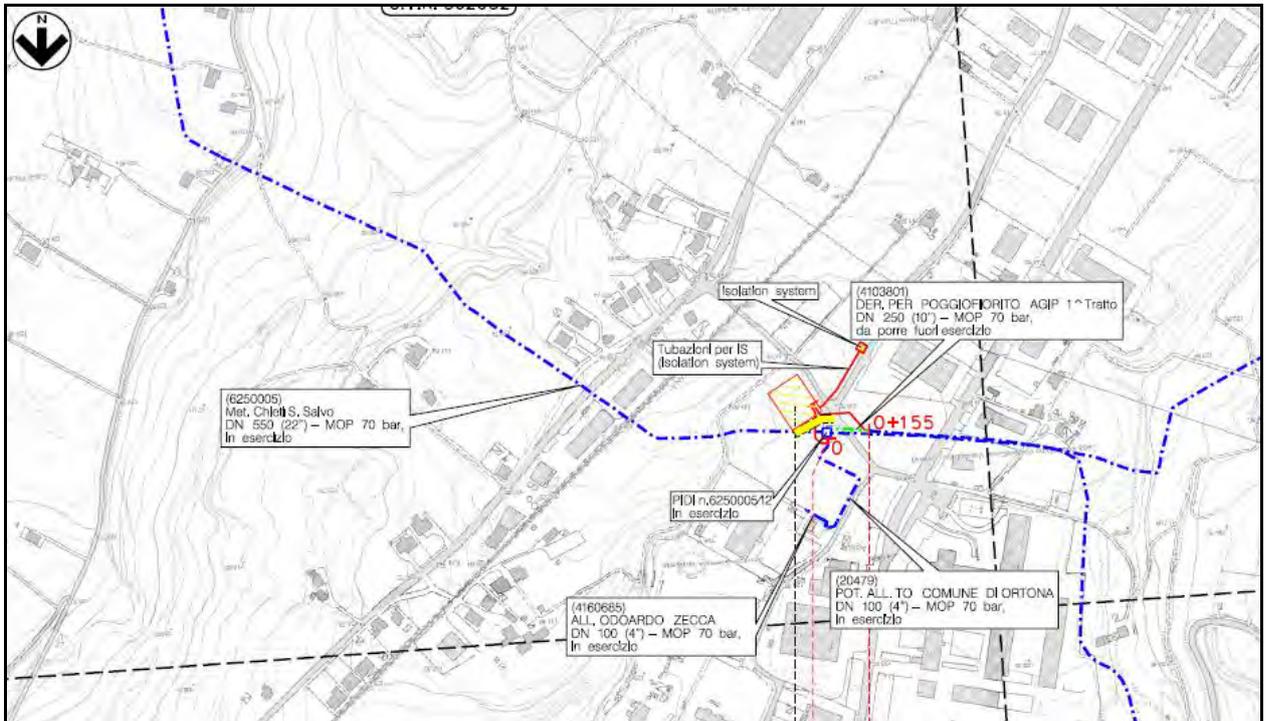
/B.b – Planimetria 1:5.000 con localizzazione dell'area dell'Intervento n.1 (progetto in rosso, dismissione in verde, esistente in blu)
